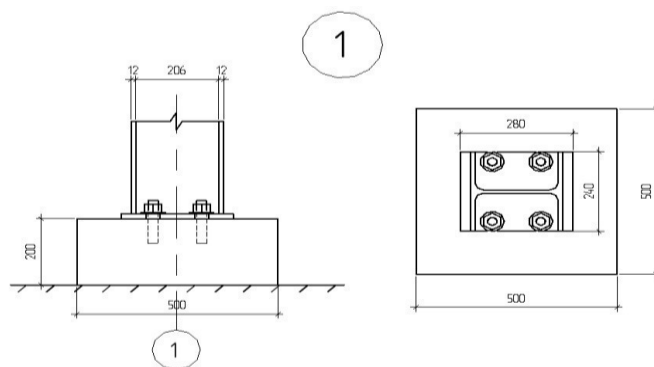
Проектное решение столбчатого монолитного фундамента
